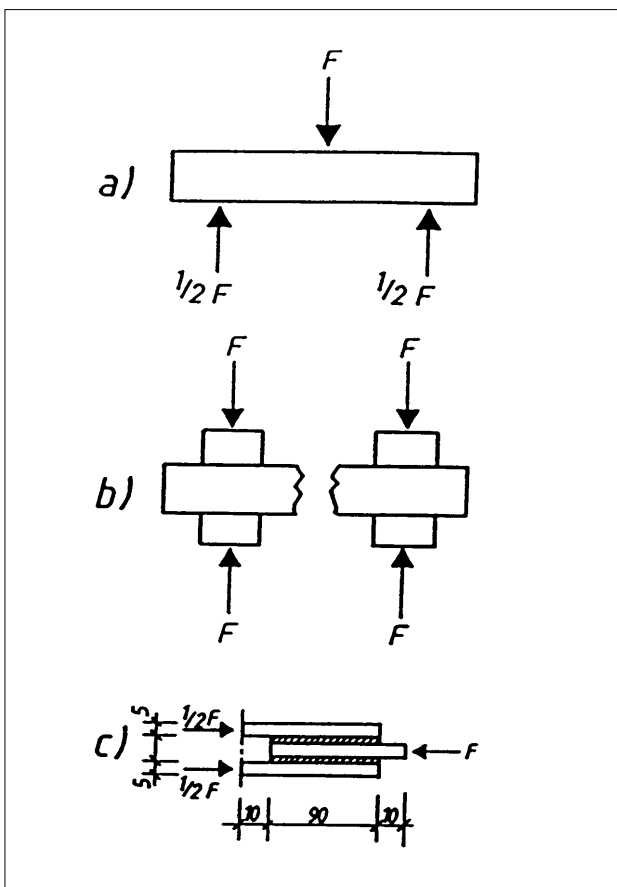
Essais pour le contrôle de la qualité du mortier de collage.
